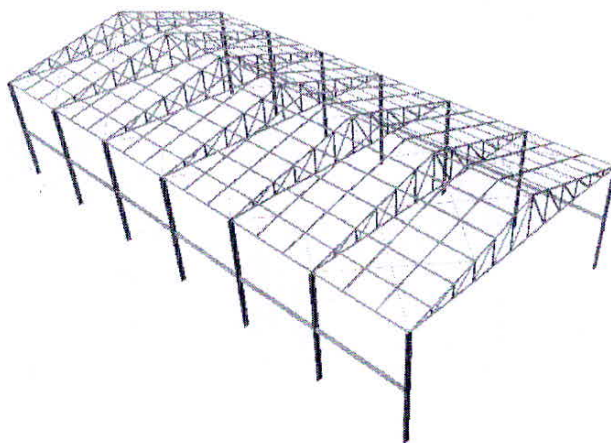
Detalhe estrutural do Galpão. – (Fonte própria).
